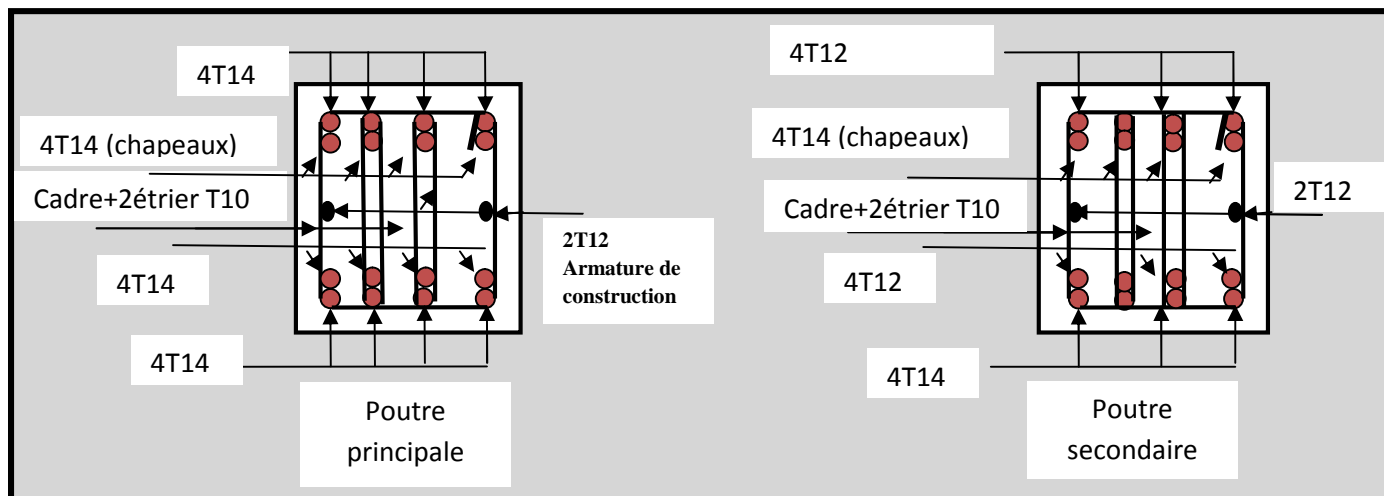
Schéma de ferrailage des poutres principales et secondaires de la Terrasse
